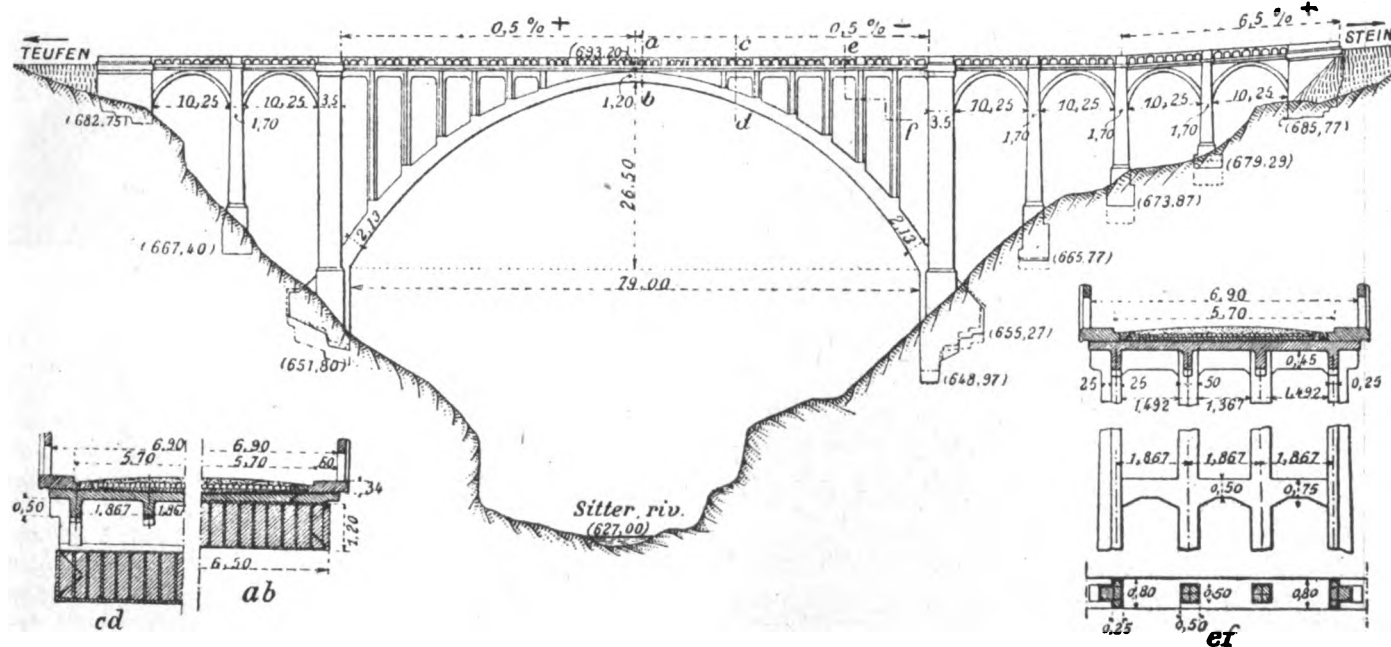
Viadotto in cemento armato sul Sitter - Elevazione e sezione.
